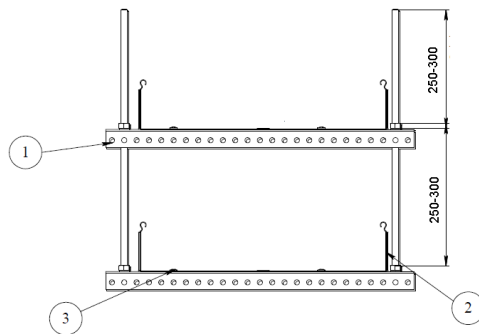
Вид подвеса (1 – П-образный профиль ВРМ; 2 – кабельный лоток; 3 – место крепления лотка к профилю)
